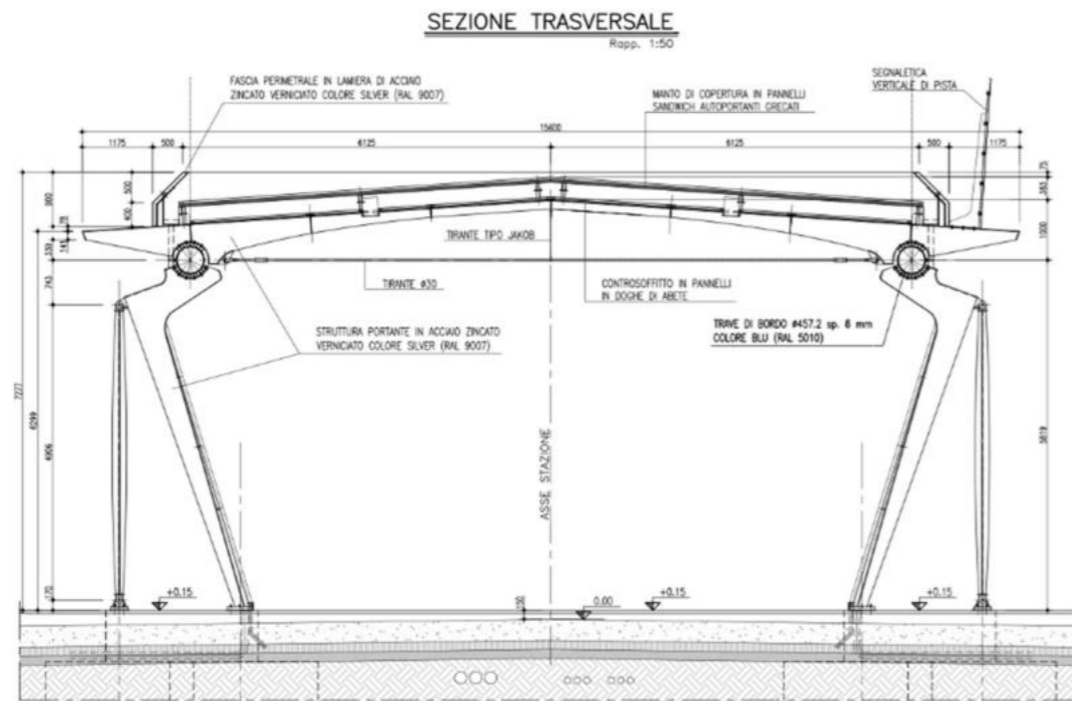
Pensilina di stazione – Prospetto e sezione
